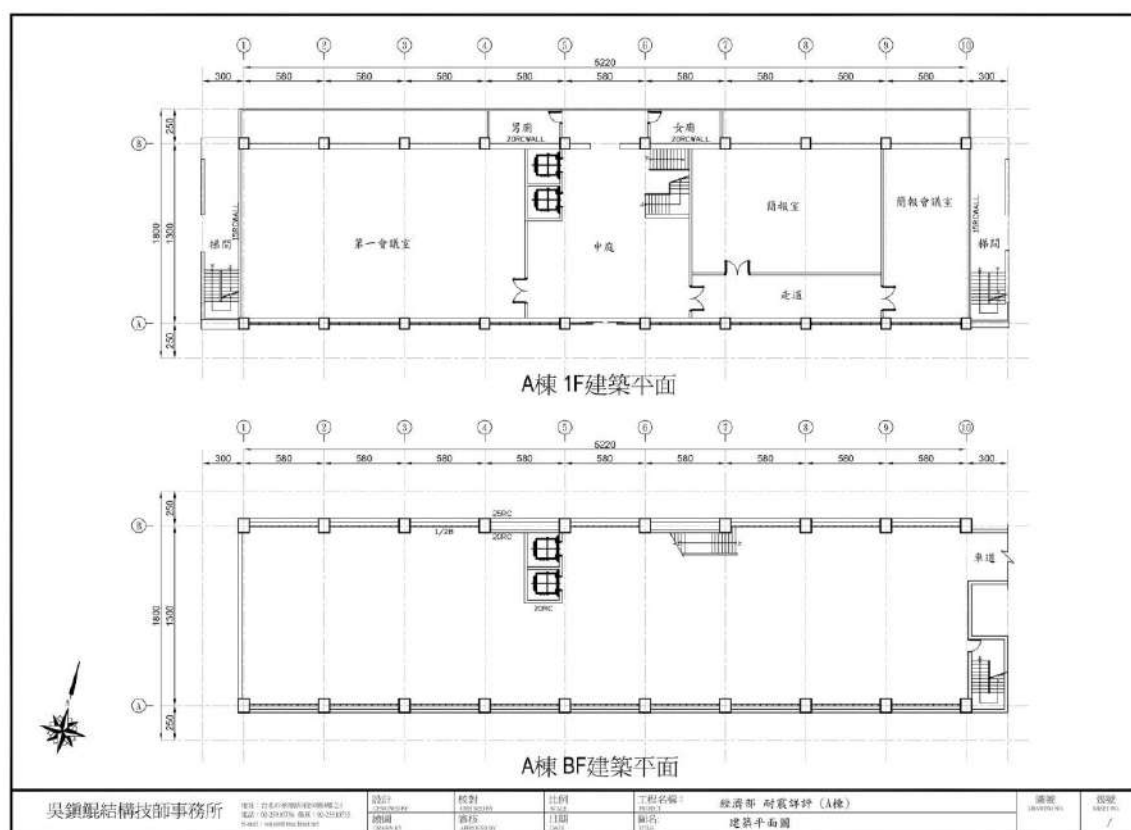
部本部 A 棟既有地下 1 層及 1 層平面圖
